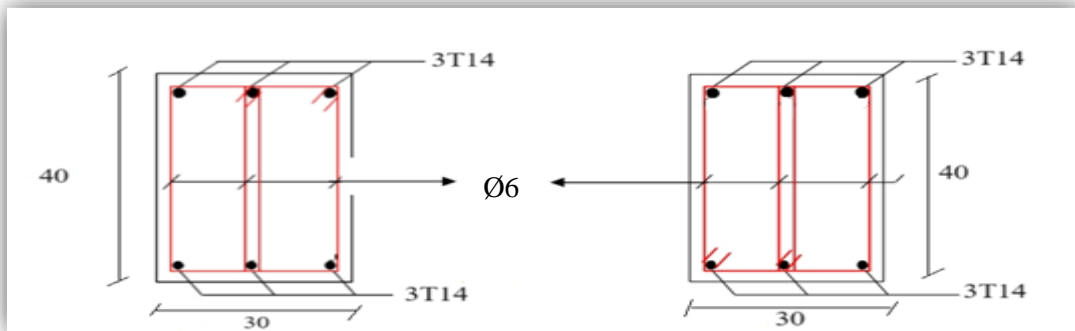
Schéma de ferrailage des poutres principales intermédiaire (Etage et Terrasse).
